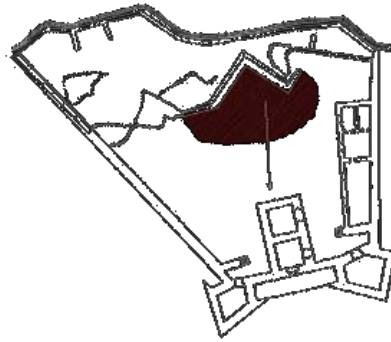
Desenho representativo do forte – elementos bateria alta e praça de armas coloridos
